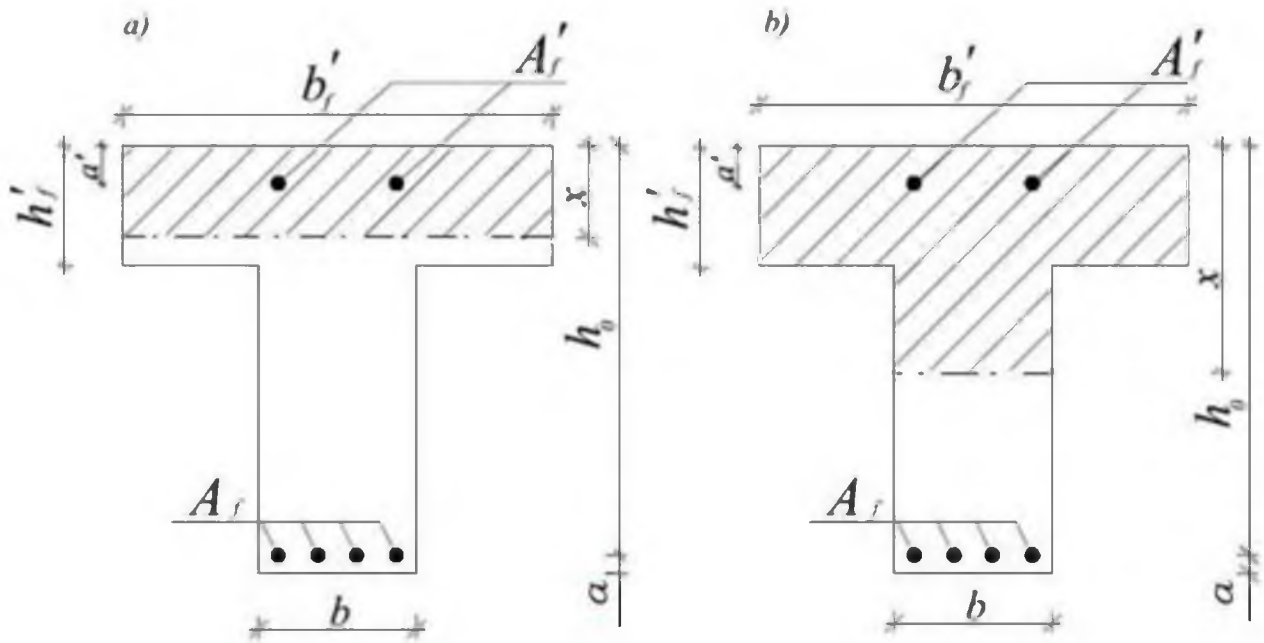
Положение границы сжатой зоны в сечении изгибаемой конструкции с композитной арматурой.
